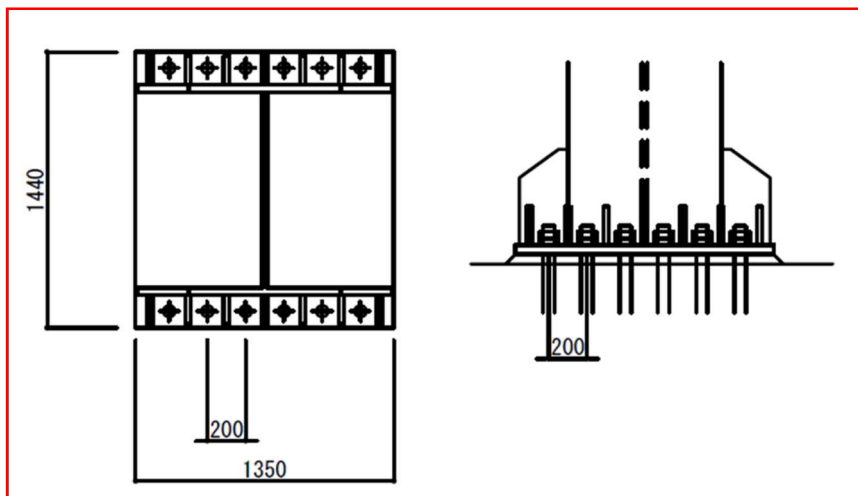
(8) 柱脚部断面图 (单位：mm)
